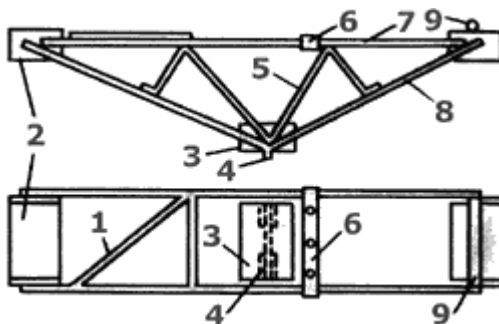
Конструкция протеза для наращивания балки перекрытия: 1 - раскос в плоскости; 2, 3 - верхняя и нижняя опорные планки; 4 - элемент жесткости нижнего пояса; 5 - решетка; 6 - передвижная планка; 7 - верхний и нижний пояса; 8 - подкос фермы; 9 - элемент жесткости верхнего пояса.
